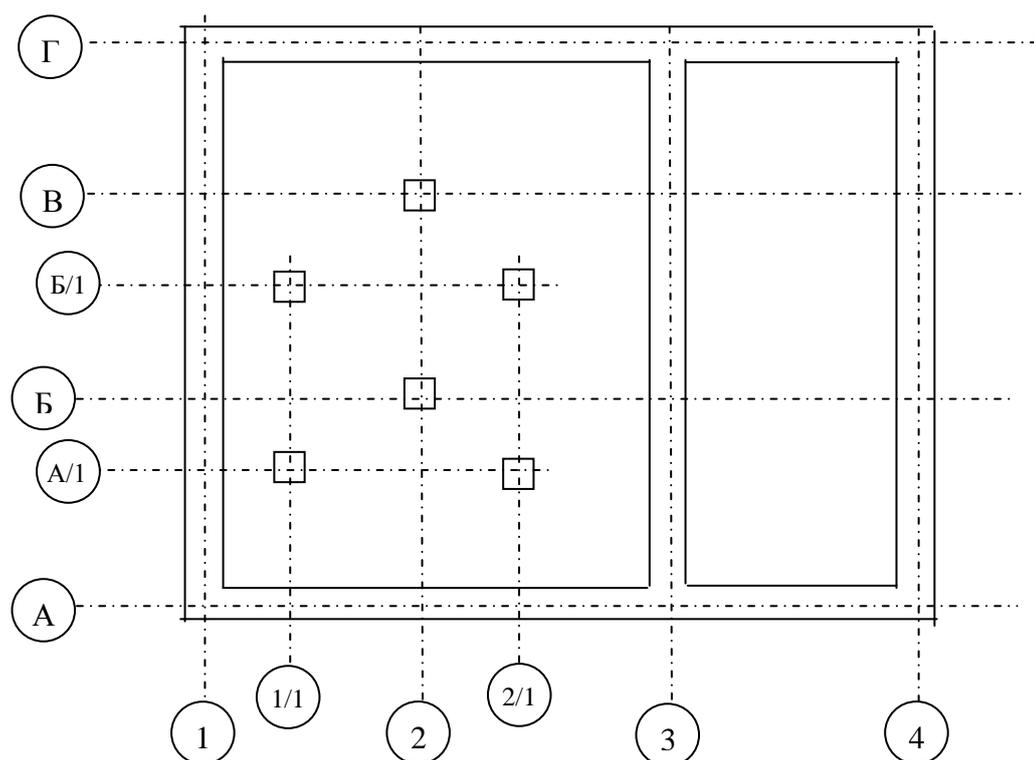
Пример обводки капитальных стен и колонн тонкими линиями
